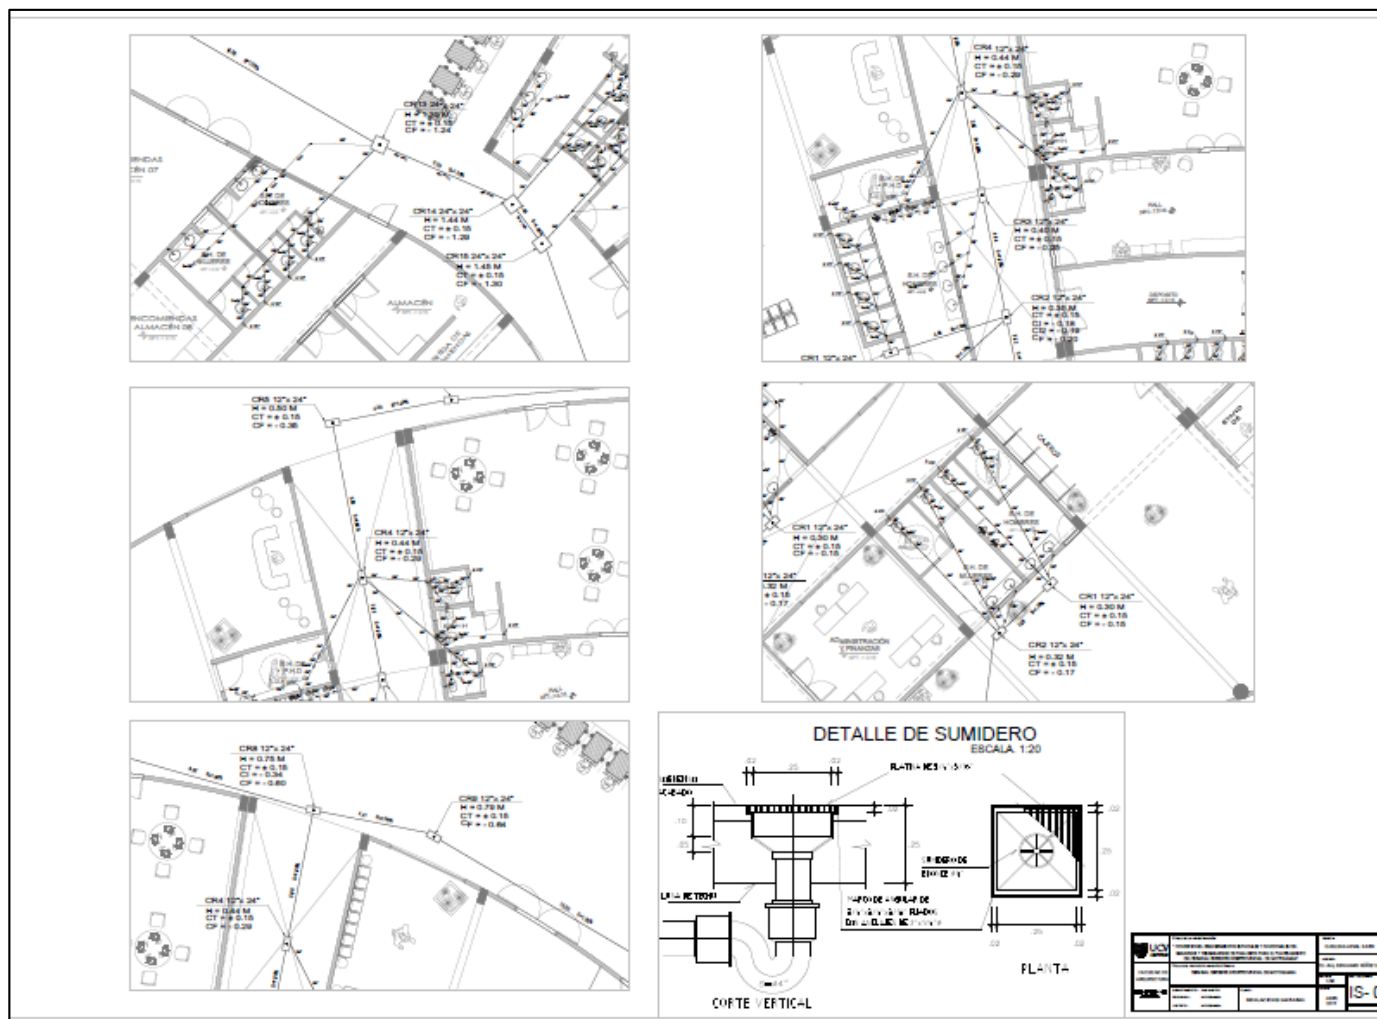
Plano instalaciones desagüe (detalles), Fuente: Elaboración propia.
